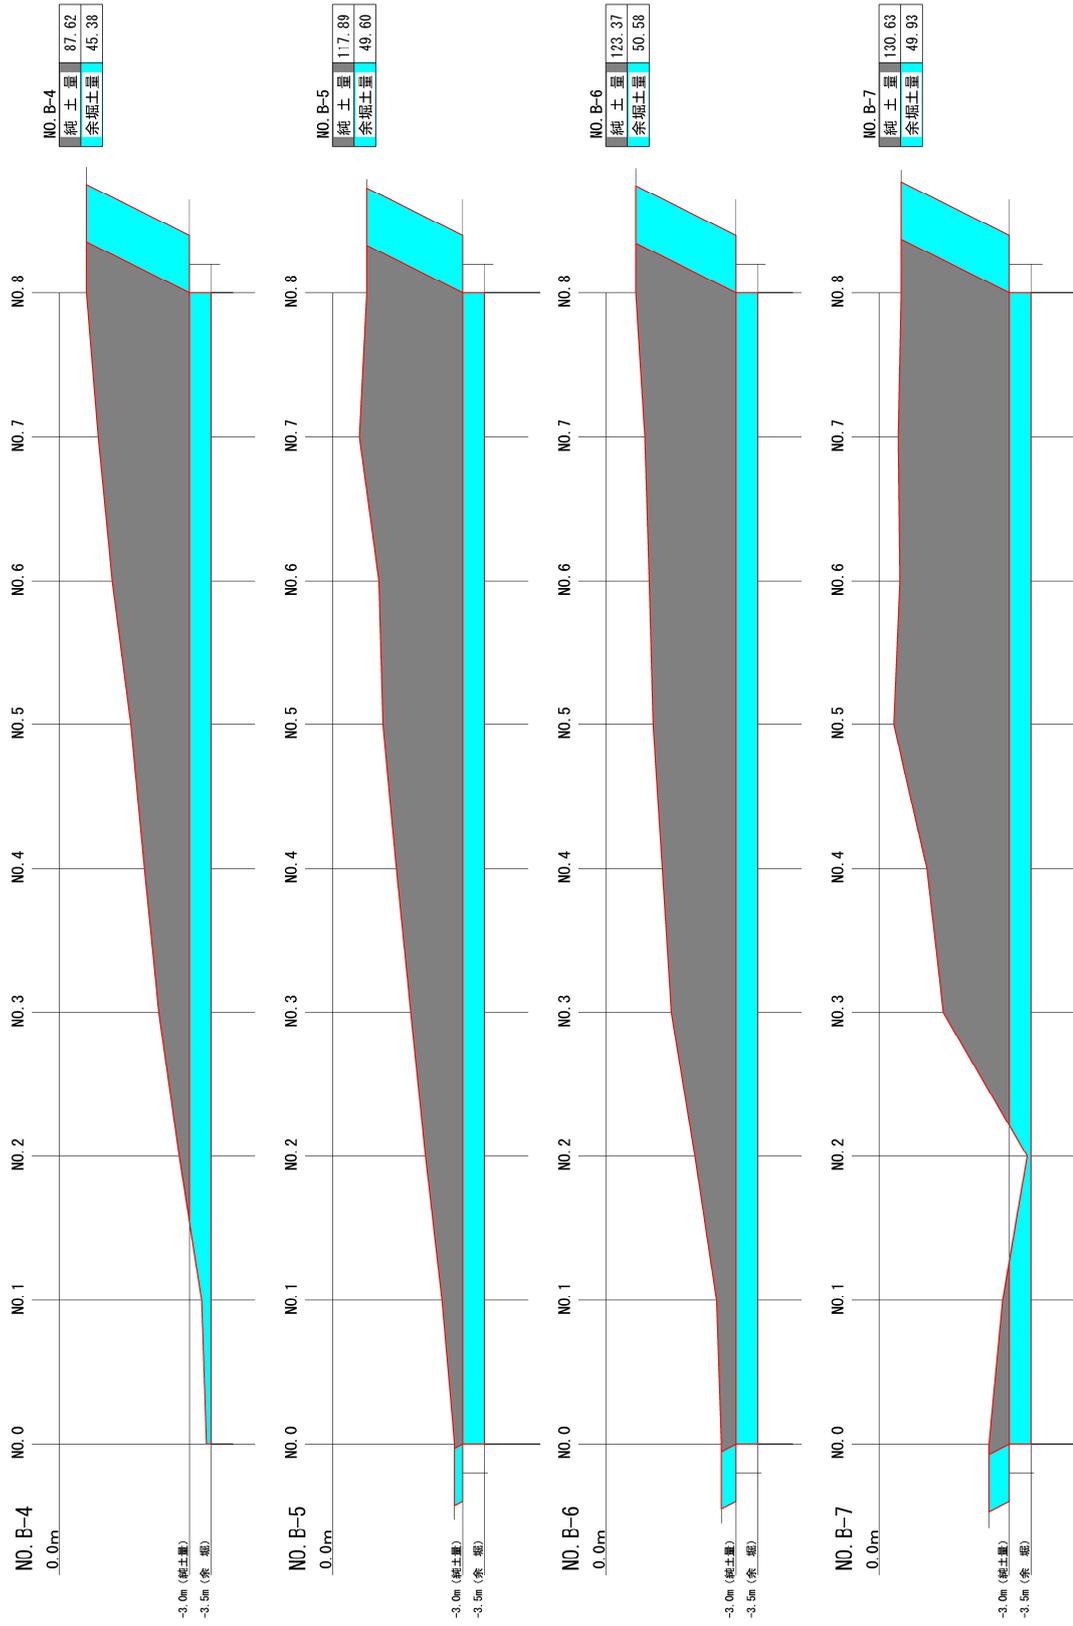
(2) 横断面 (B区) (測線 No. B-4~B-7)
